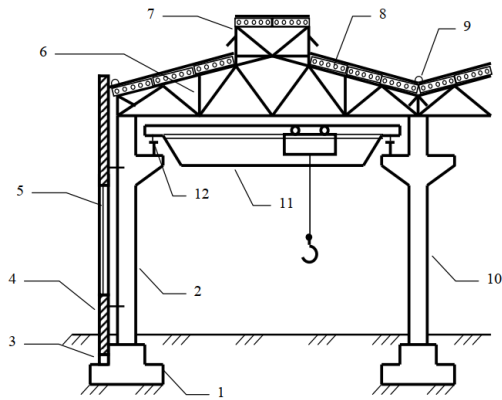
Типове конструктивне рішення промислової будівлі: 1 – фундамент; 2 – крайня колона; 3 – фундаментна балка; 4 – стіна; 5 – заklenня; 6 – сталева ферма; 7 – світловий ліхтар; 8 – з/б плити покриття; 9 – лійка водовідводу; 10 – середня колона; 11 – мостовий кран; 12 – підкранова балка
